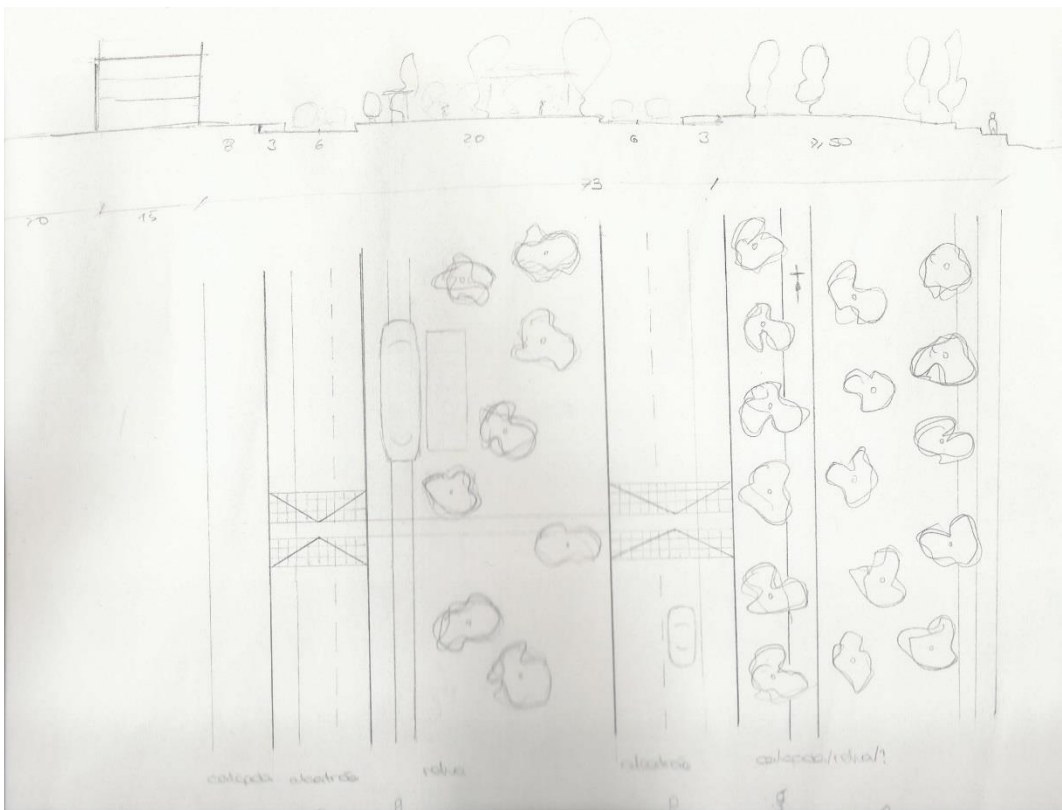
Corte e planta de referfilamento da Av. Infante D. Henrique. Fonte: Autora
